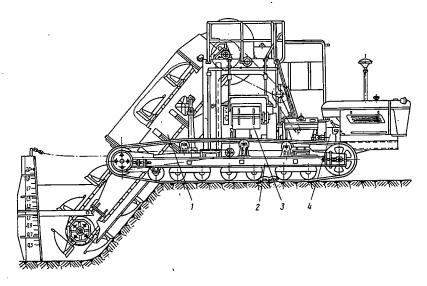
Машина К-1БМ для рытья и ремонта картовых канав: 1 — рабочий аппарат; 2 — гуссинчный ход; 3 — поперечный конвейер; 4 — двигатель
